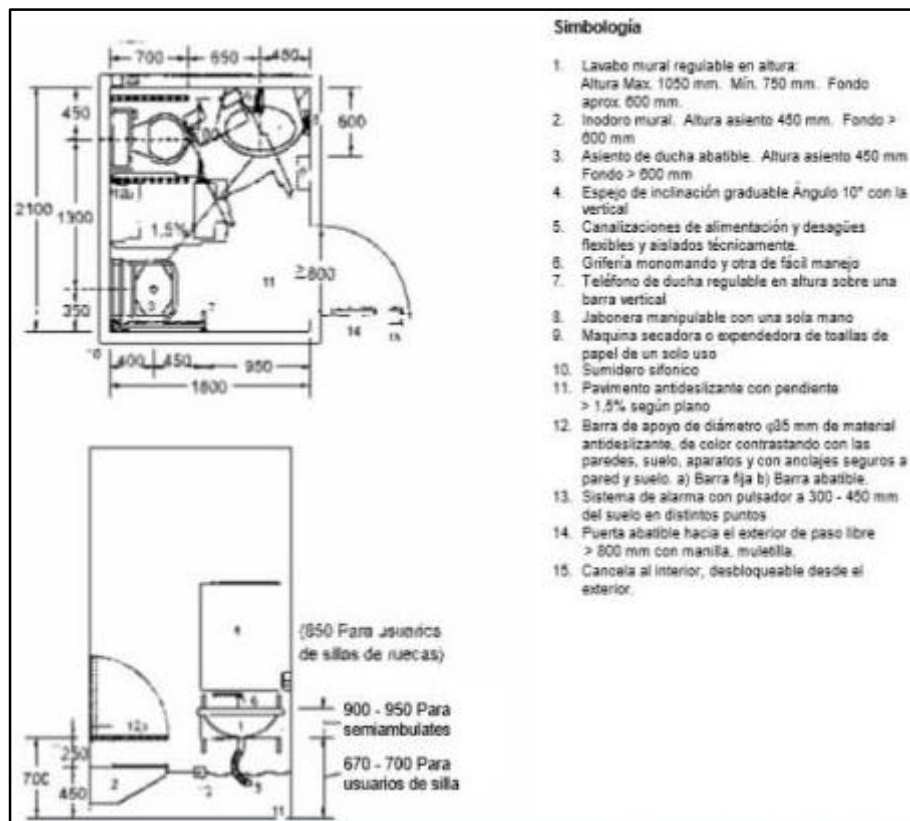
Condiciones de las baterías sanitarias y barra de apoyo.
